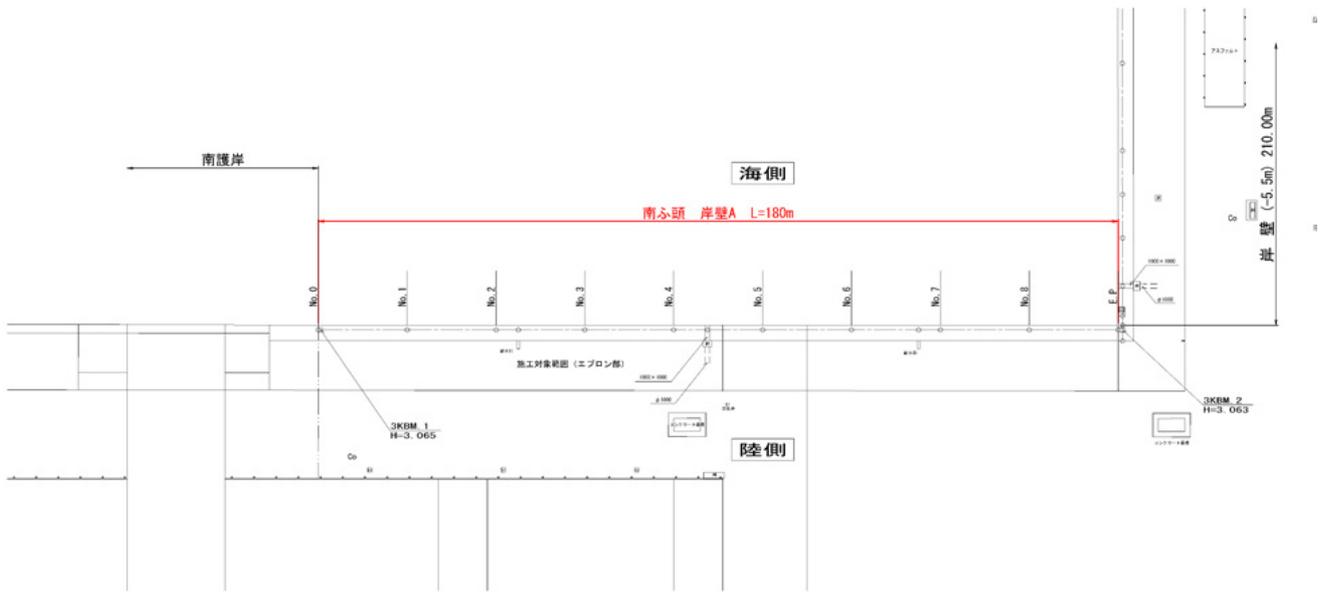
238 No.21 常陸那珂港区_南ふ頭地区 A 岸壁 (-5.5m) の平面図 (被災前)
